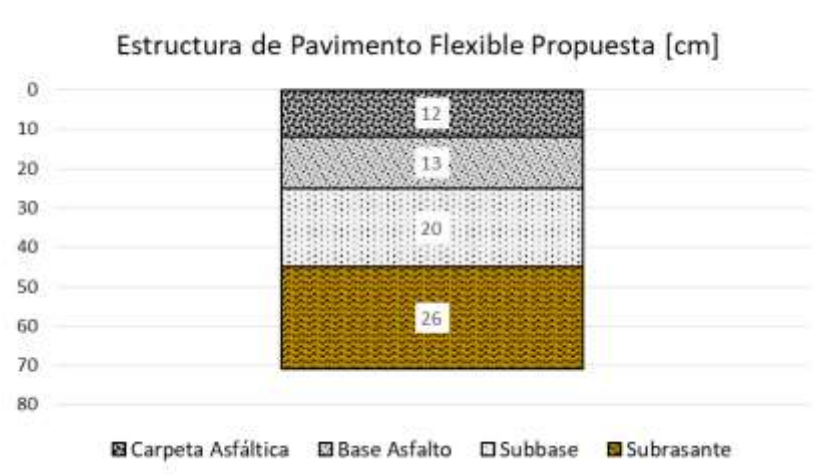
Estructura de Pavimento Flexible Propuesta
